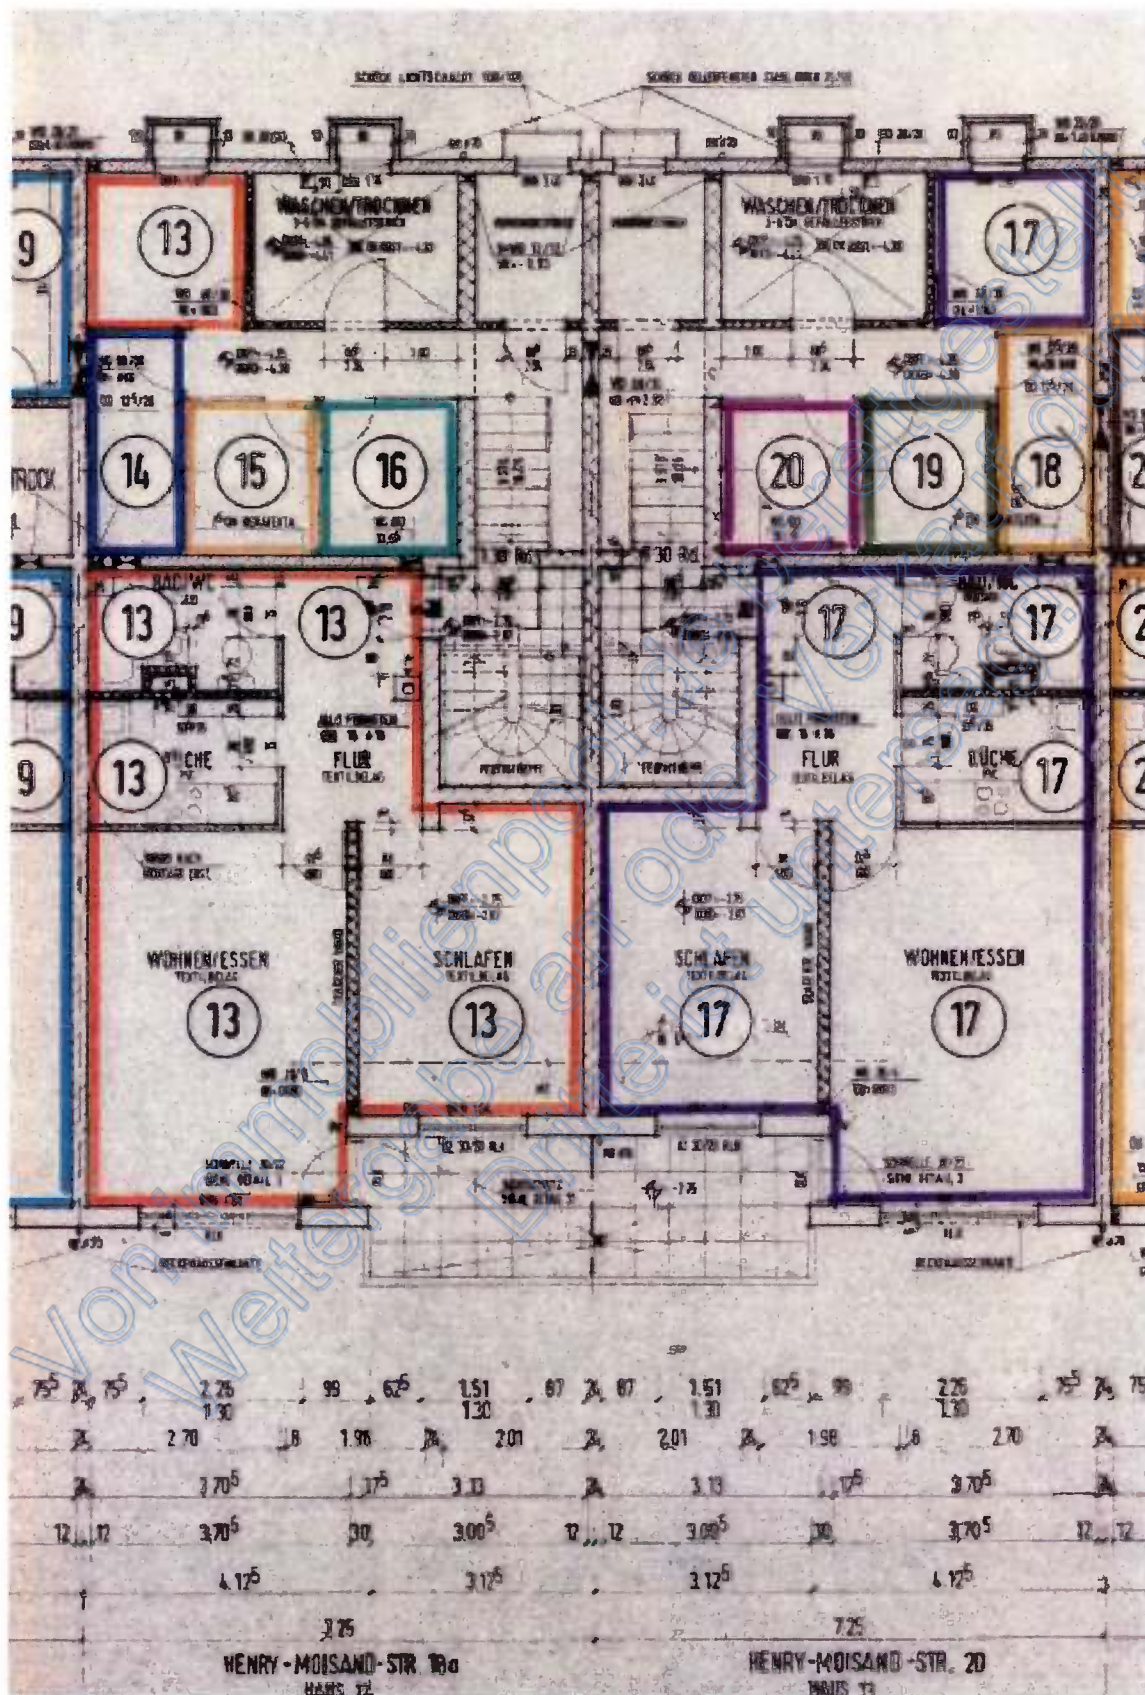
Grundriss Kellergeschoss, Haus 12, 13, Henry-Moisand-Str. 18 a, 20; Quelle: Bauakte
